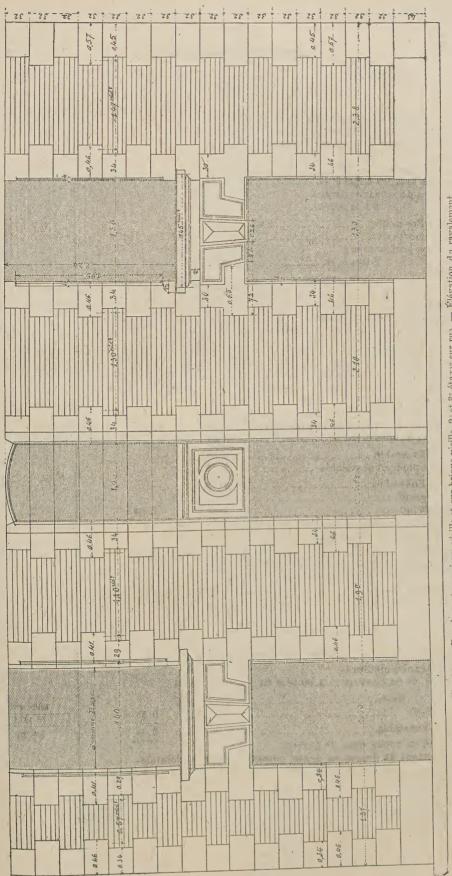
Ravalement sur pierre vieille et sur brique vieille, 2º et 3º étages sur rue. — Élévation du ravalement.
